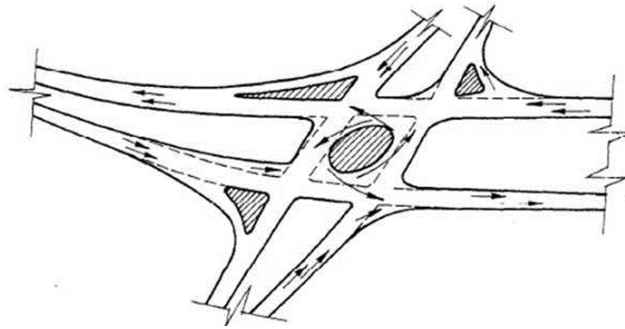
Intersección tipo Cruz de carreteras con calzadas separadas.
